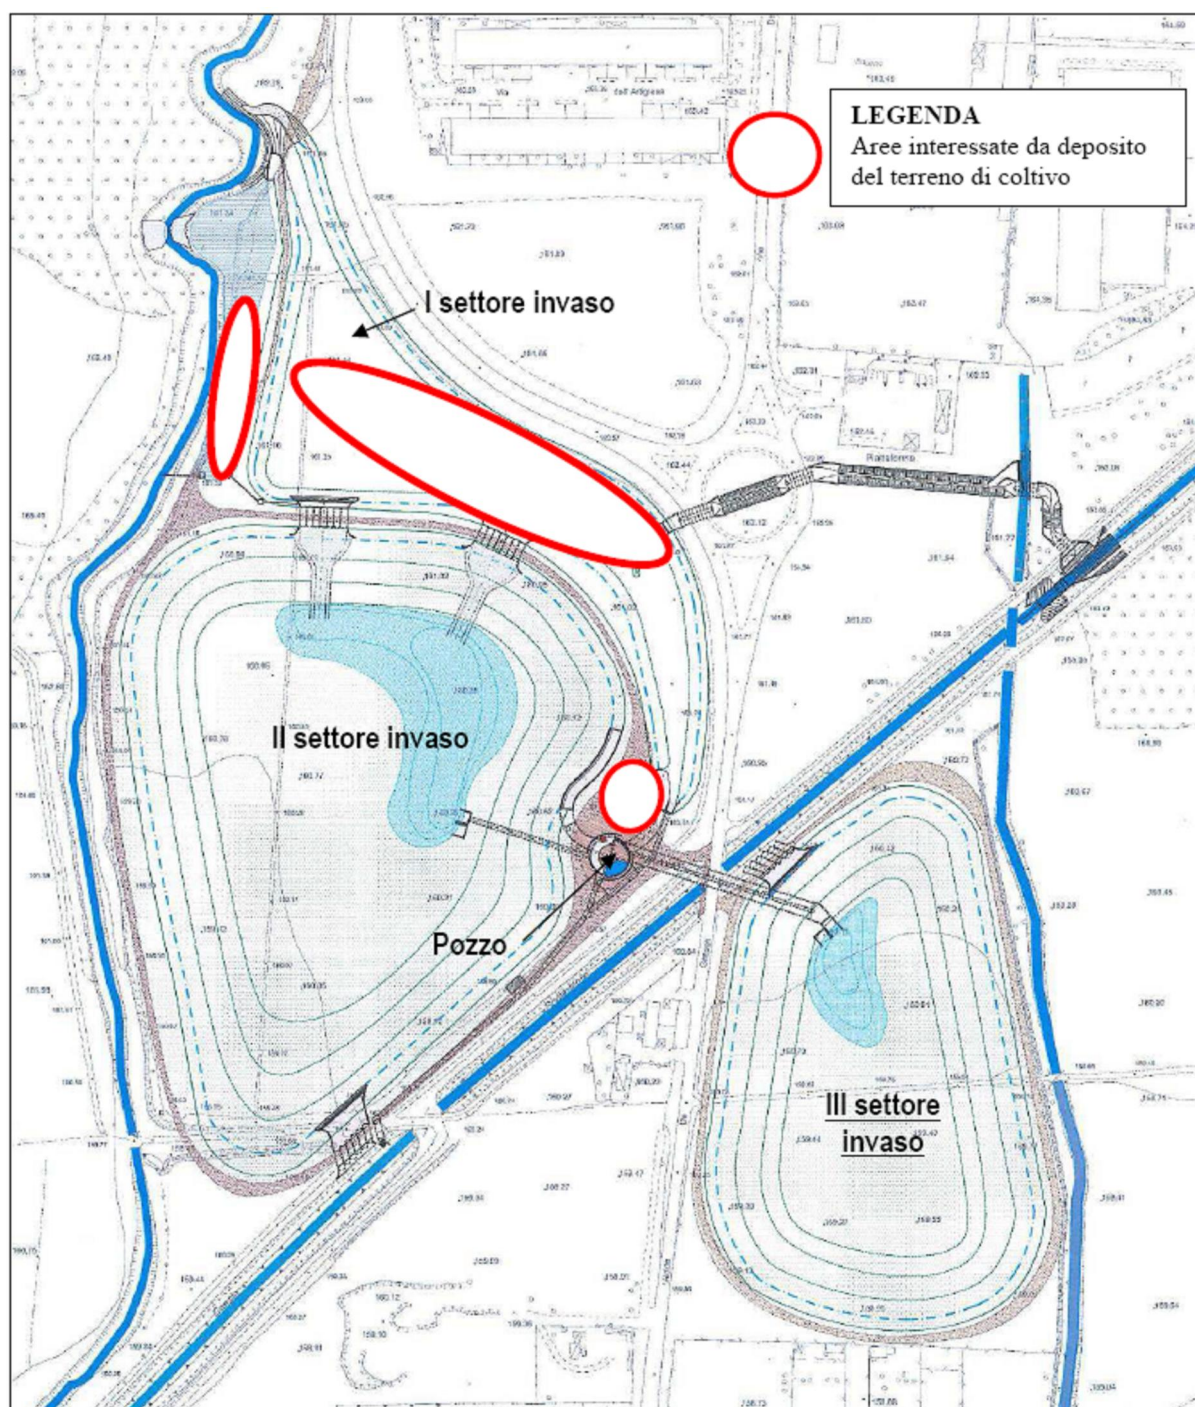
Planimetria delle opere in progetto con indicazione delle aree interessate dallo stoccaggio temporaneo da utilizzarsi nell’ambito del cantiere per i ripristini superficiali
